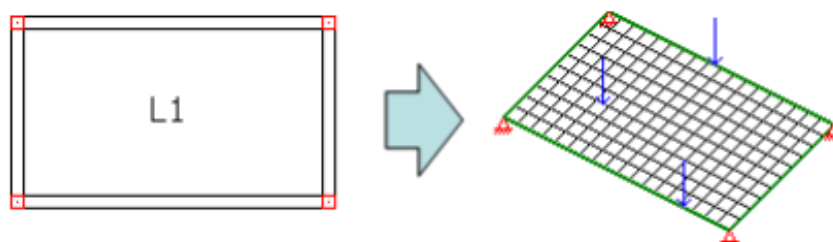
Grelha de lajes e vigas. (TQS Docs, 2021)
